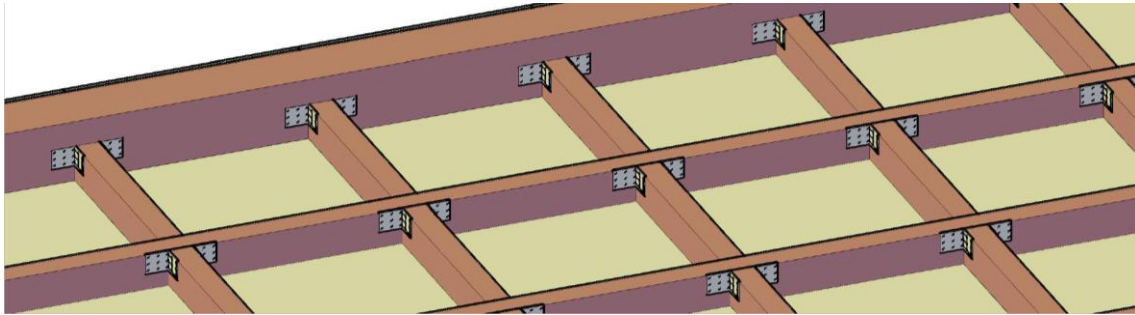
Elementos metálicos a conectar as vigas da cobertura entre si no anteprojeto.
